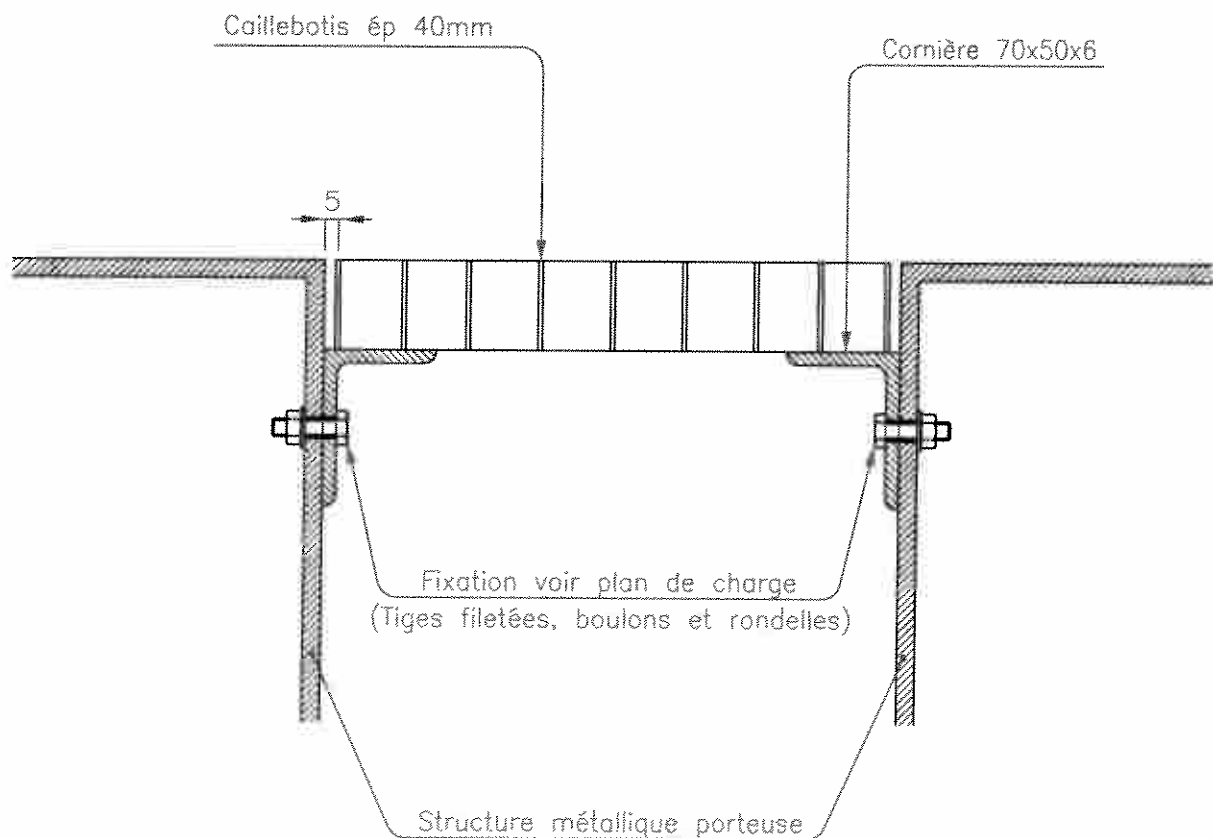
PLATELAGE — BORDURE EN CONSOLE SUR STRUCTURE METALLIQUE
